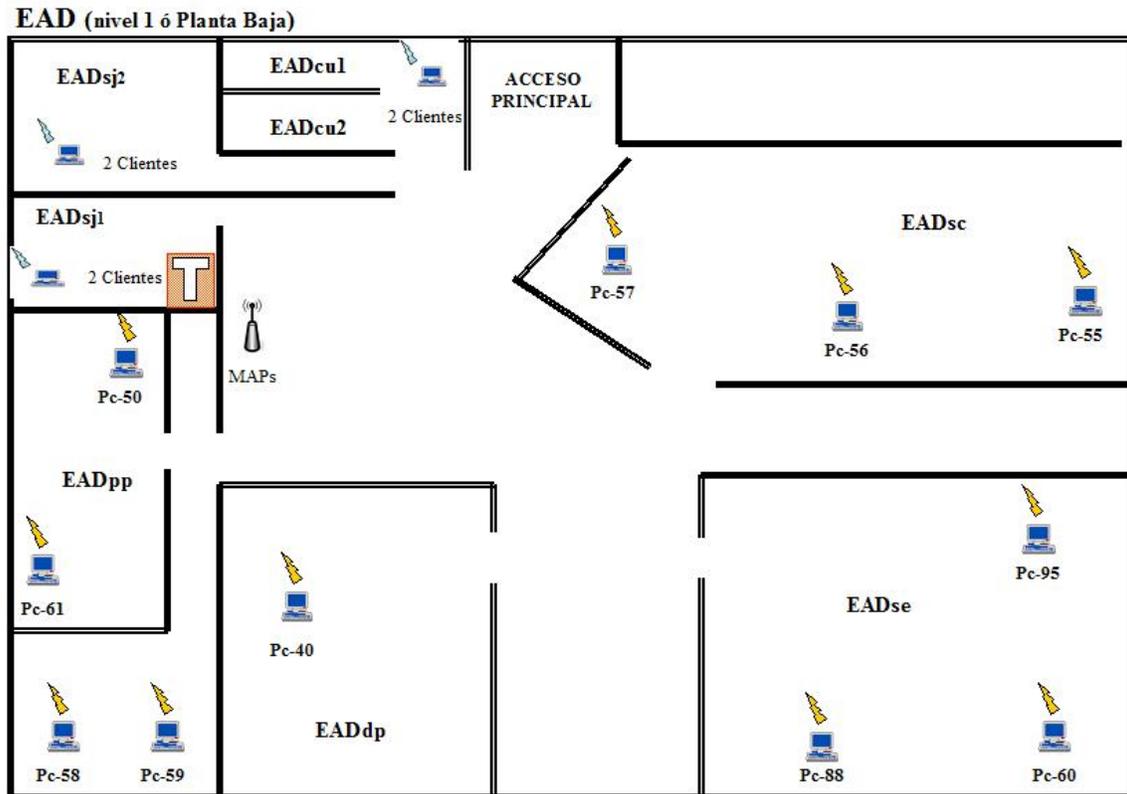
Esquema del Edificio Admón. Nivel 1 ó Planta Baja.
